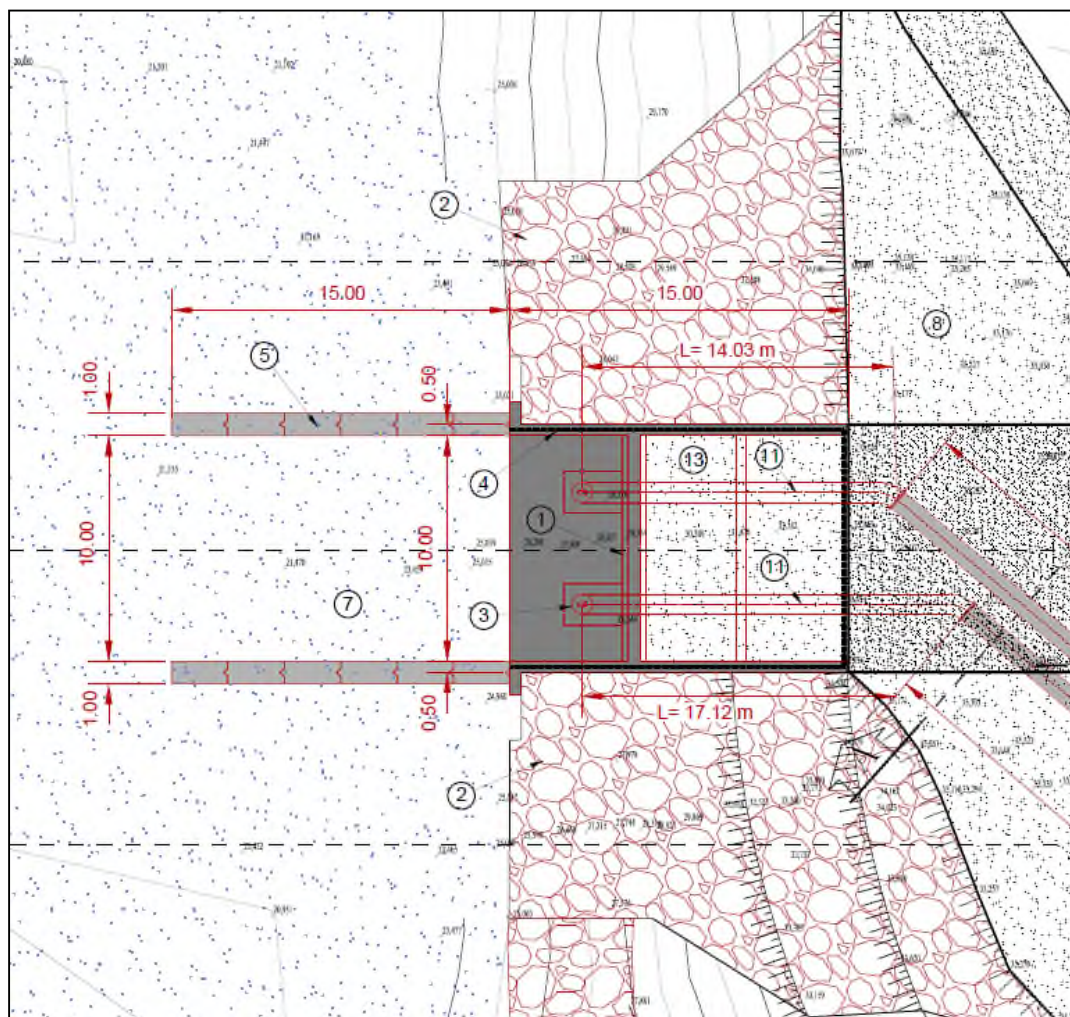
Stralcio planimetrico dell'opera di presa in progetto
